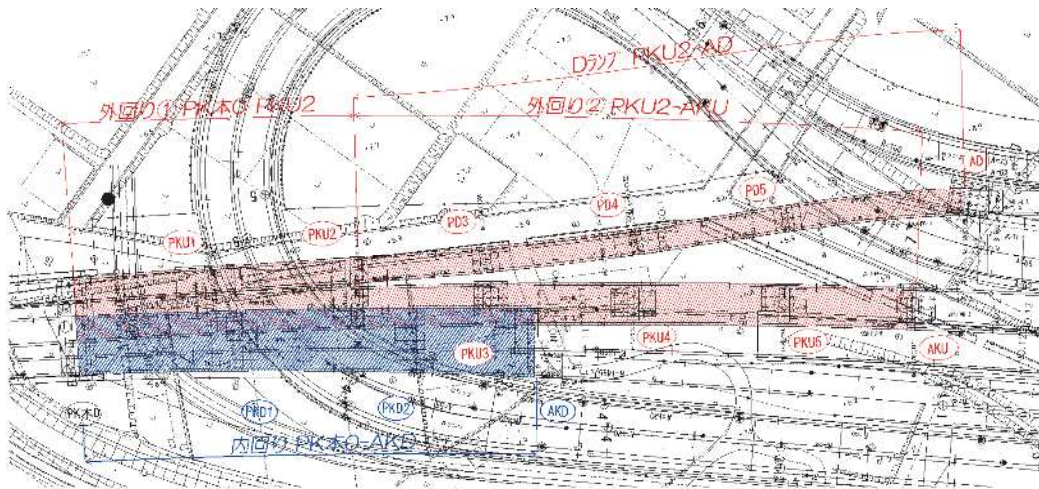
膨張材併用軽量床版施工箇所（平面図）
